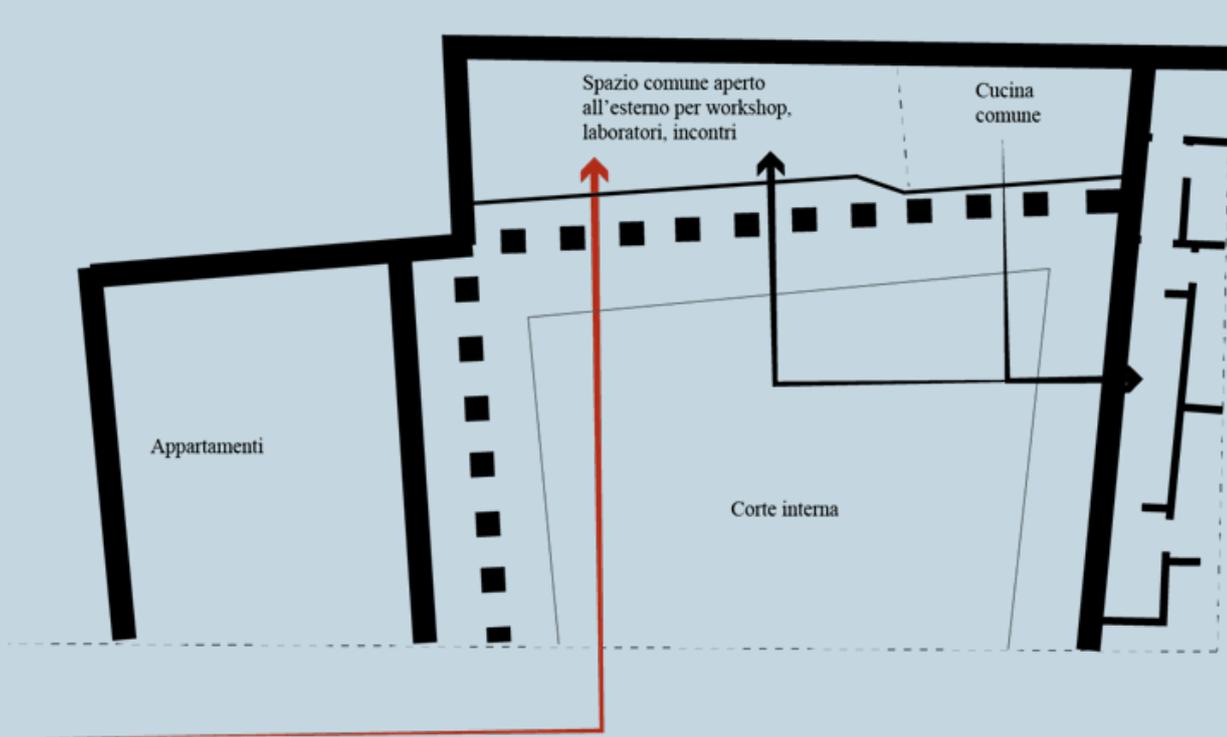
RAPPRESENTAZIONE IN PIANTA DEGLI SPAZI COLLETTIVI INTERNI ED APERTI ALLA COMUNITÀ
